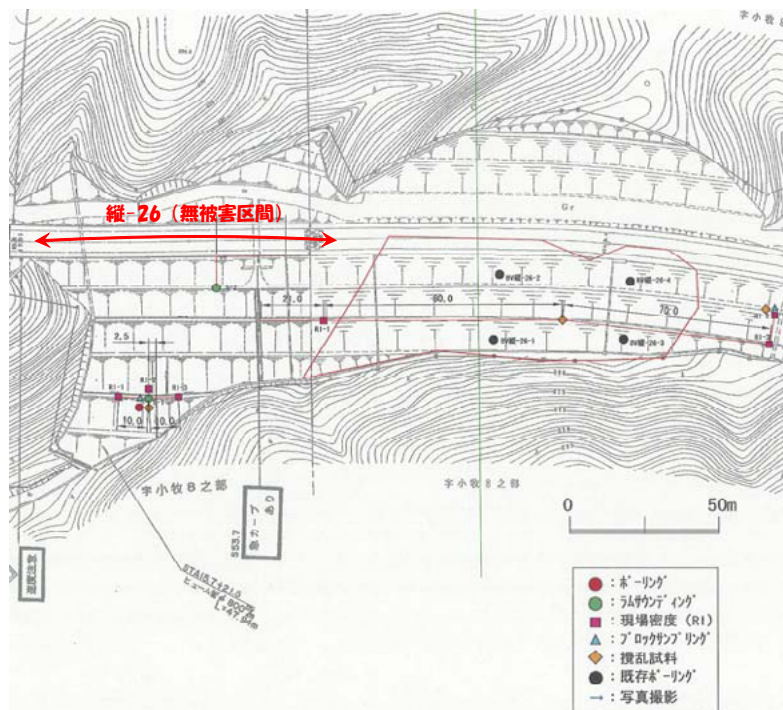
平面図（能登有料 七尾氏中島町小牧その12 15.9kp 縦-26 隣接）
